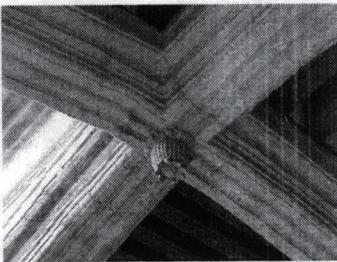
Cruce de arcos rebajados con piña invertida, nivel planta alta.
